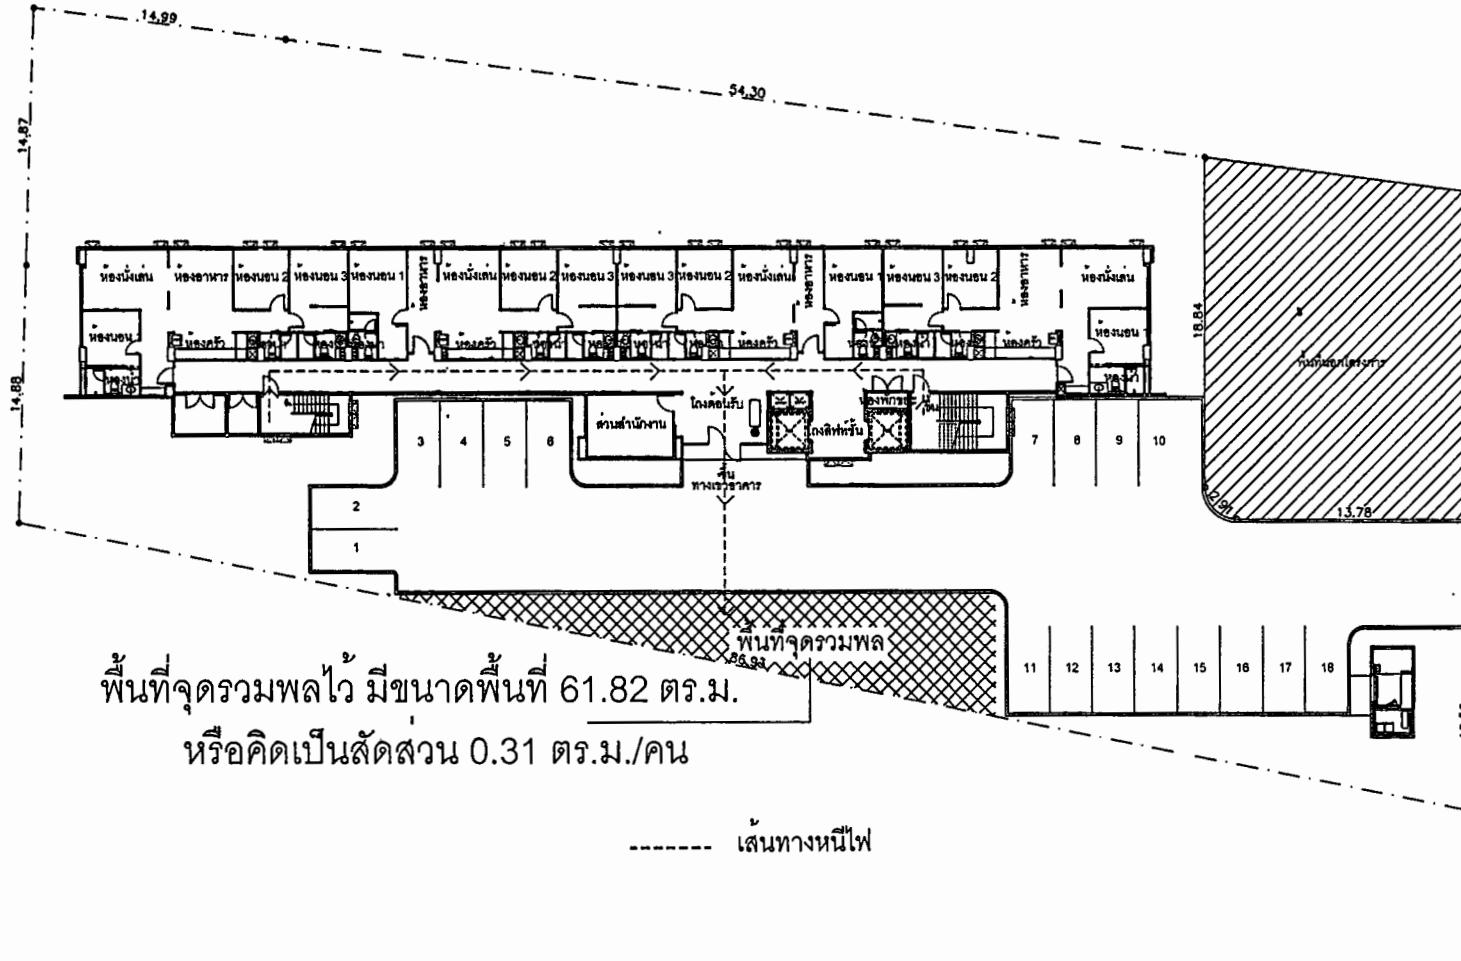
แสดงผังเส้นทางหนีไฟชั้น 3-5 และชั้น 6-7
